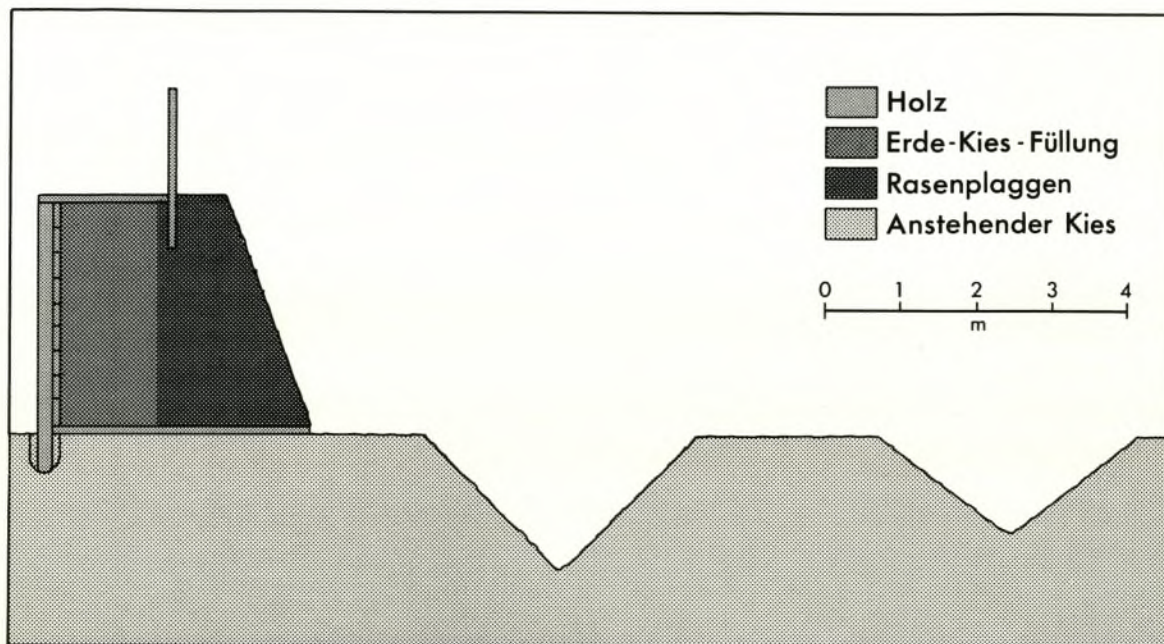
Nersingen. Schematischer Rekonstruktionsversuch der Umwehrung des Kleinkastells. Schnitt durch die Holz-Rasensodenmauer und die Gräben. M. 1:100.
